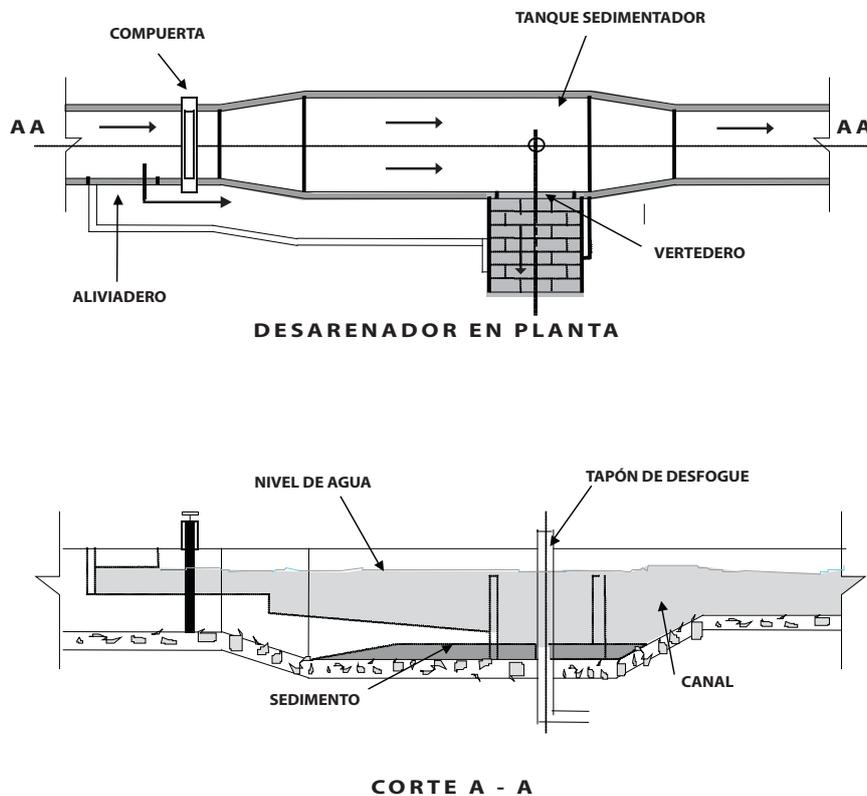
VISTA DE PLANTA Y LATERAL DE UN DESARENADOR
